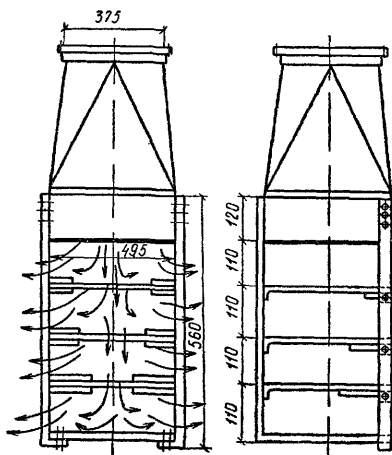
Трехсторонний прямоугольный насадок с полками
